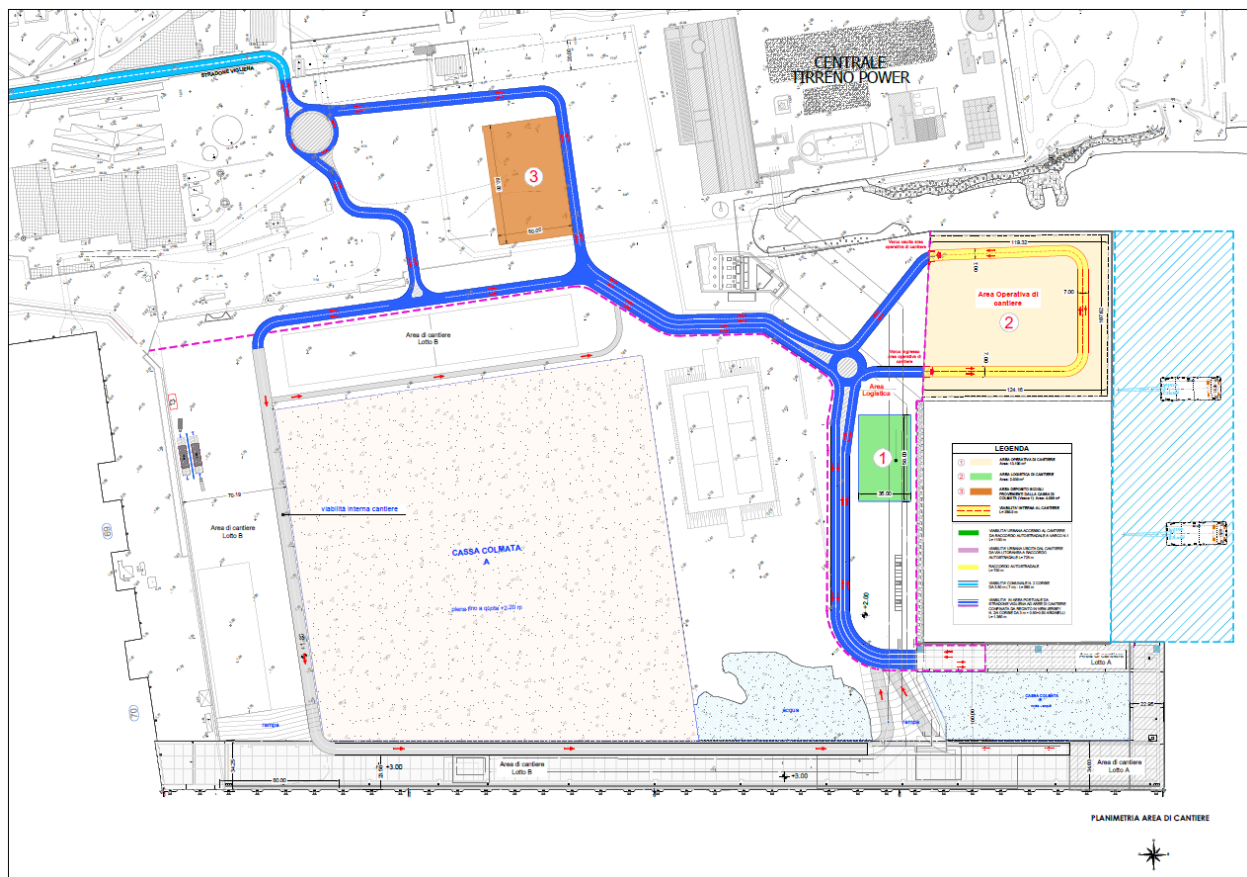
Planimetria delle aree di cantiere, della logistica e della viabilità di cantiere (elaborato MI061P-PDRT4008 -ALL.03)
